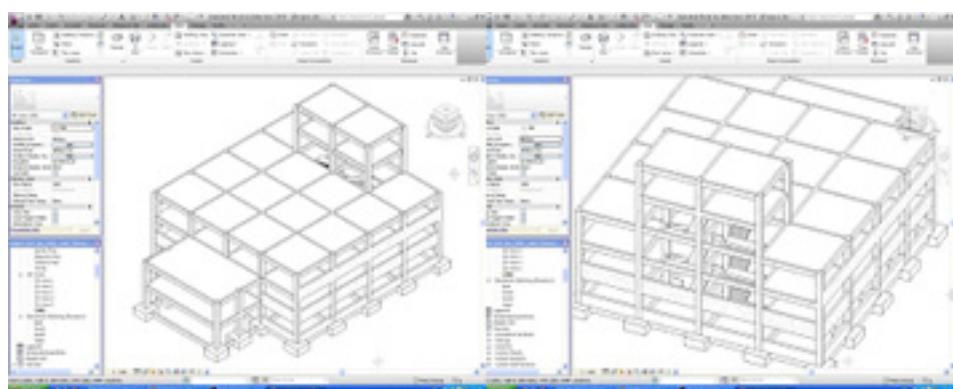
ArchiCAD 14 – Modelo estrutural de concreto armado
